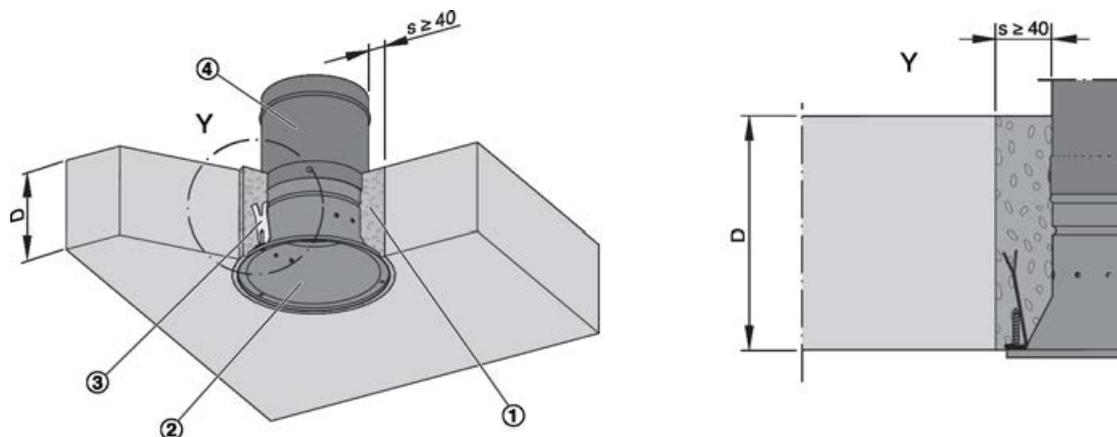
Montage à base de mortier dans la dalle du plafond
